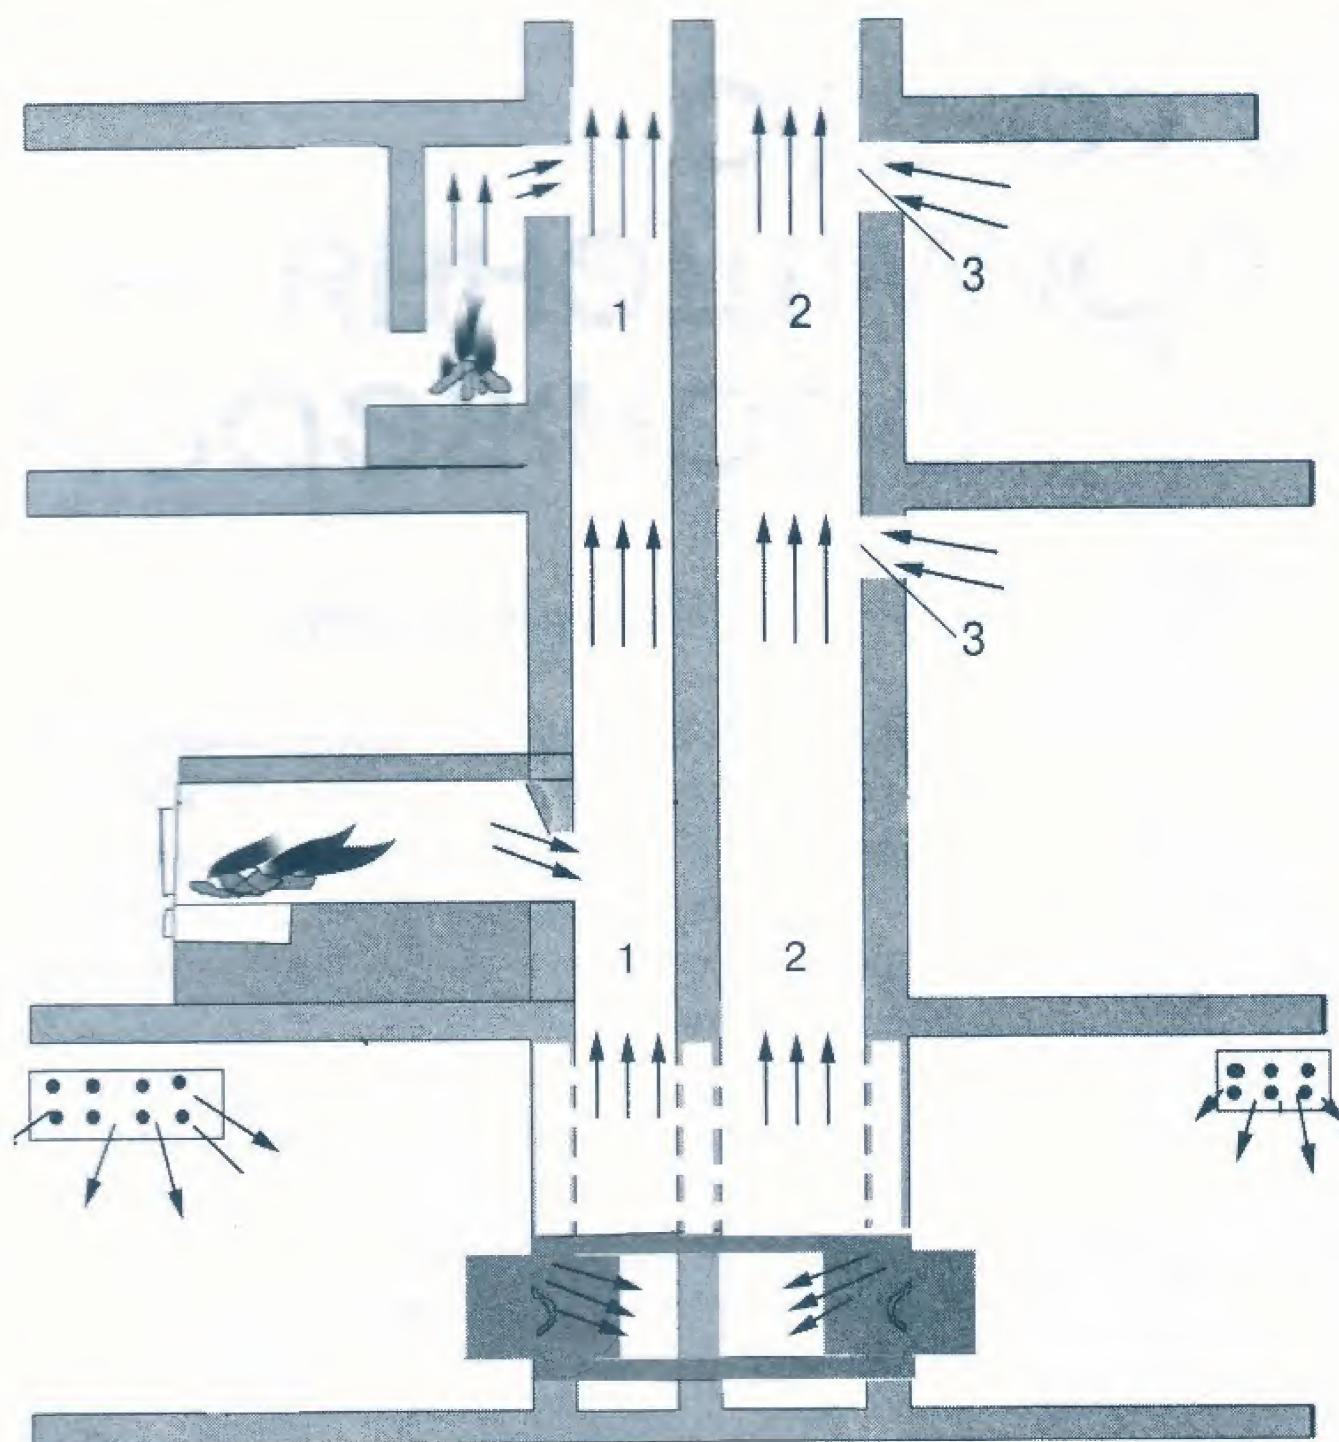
Схема пічного опалення і вентиляції приміщень підвалу, 1 і 2-го поверхів: 1 — димохід; 2 — вентиляційна шахта; 3 — вентиляційні отвори на 1 і 2-му поверхах будинку
